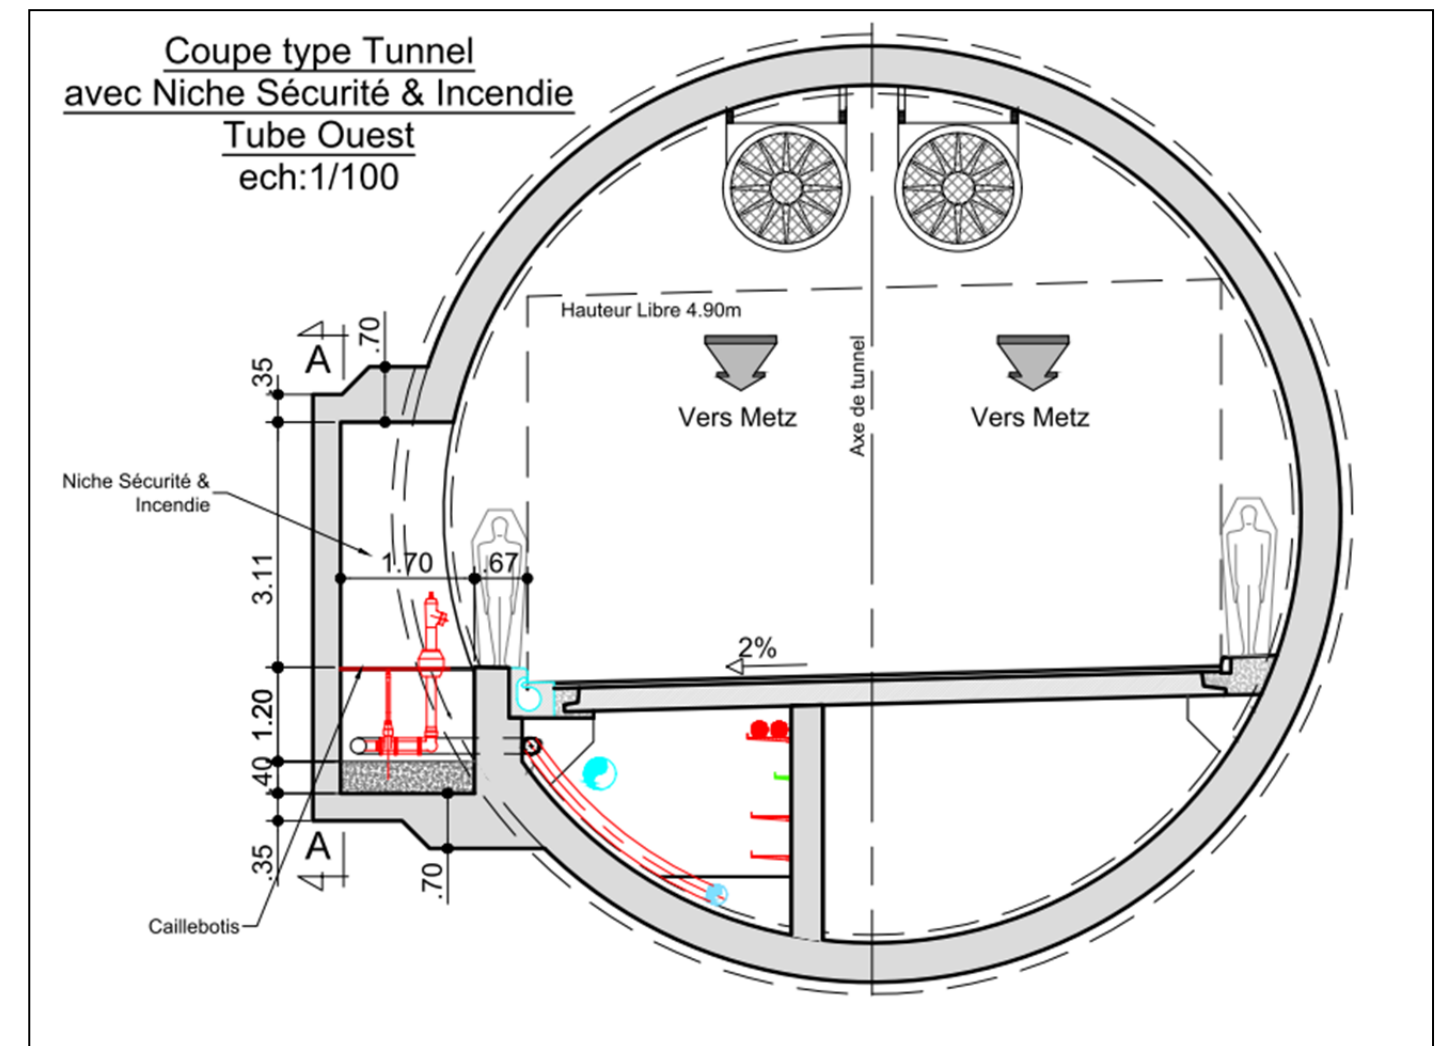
Profil en travers envisagé d'un tube du tunnel
